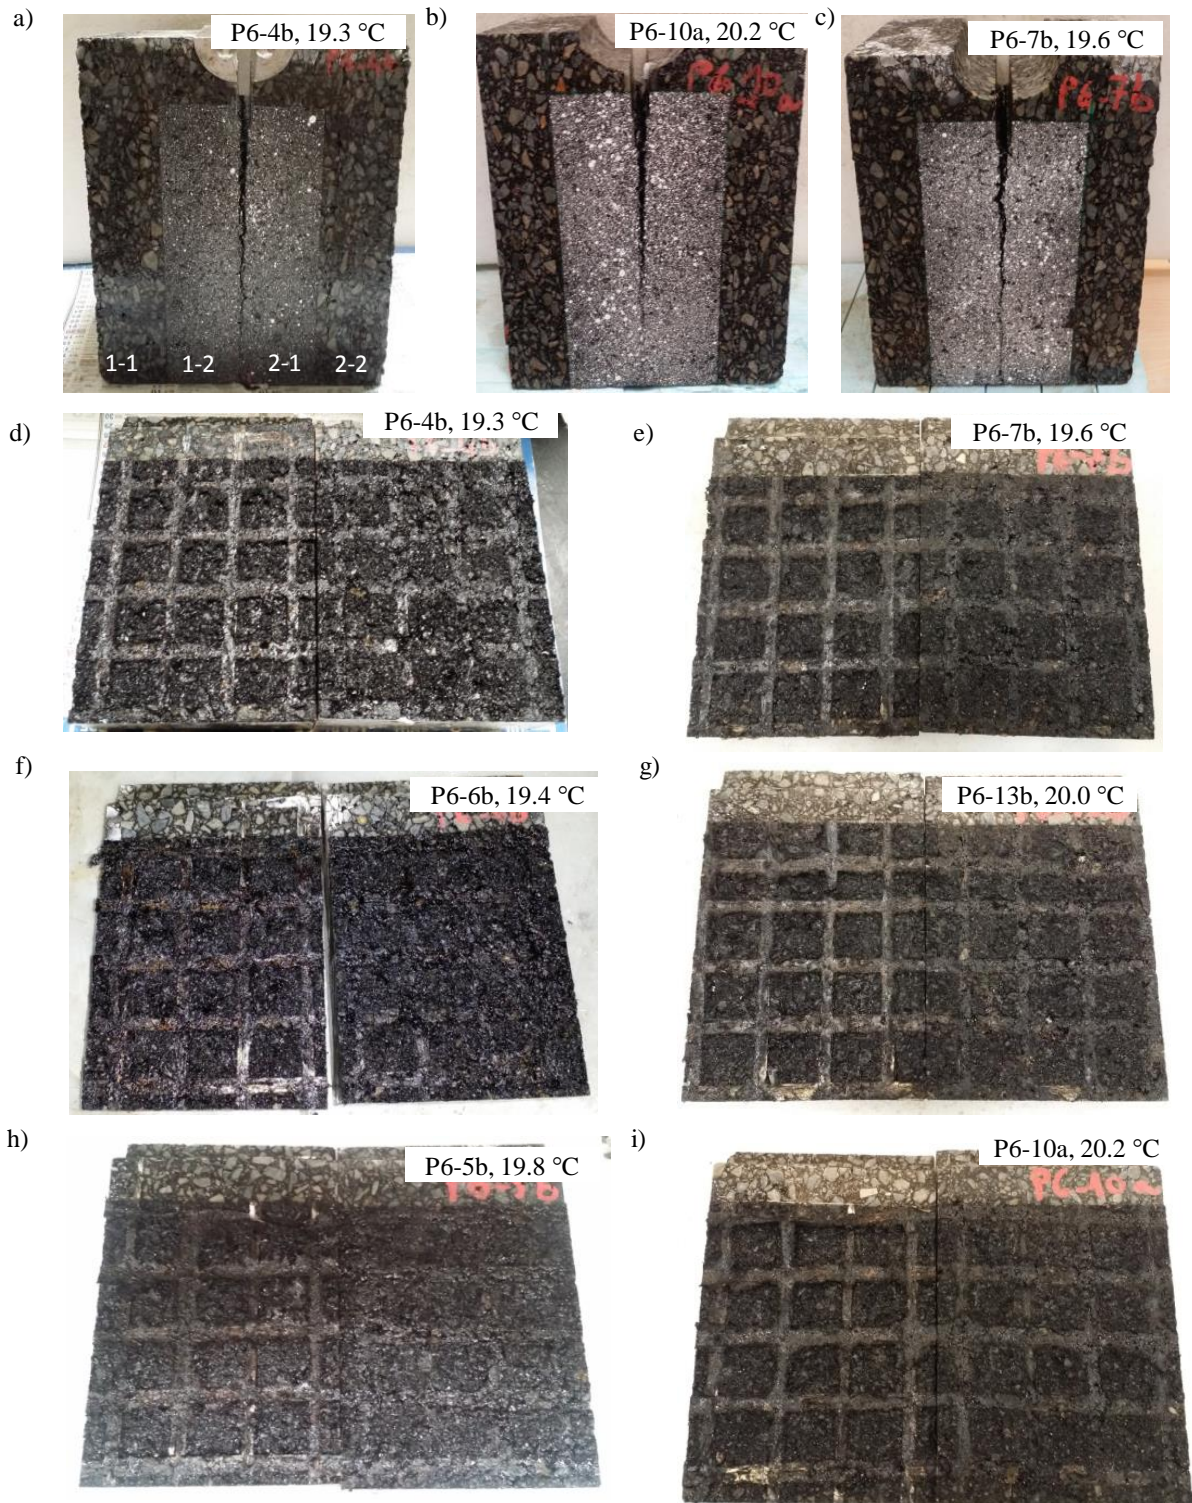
Surfaces de ruptures des éprouvettes P6 renforcées par la grille G3 testées à 20°C sous eau
